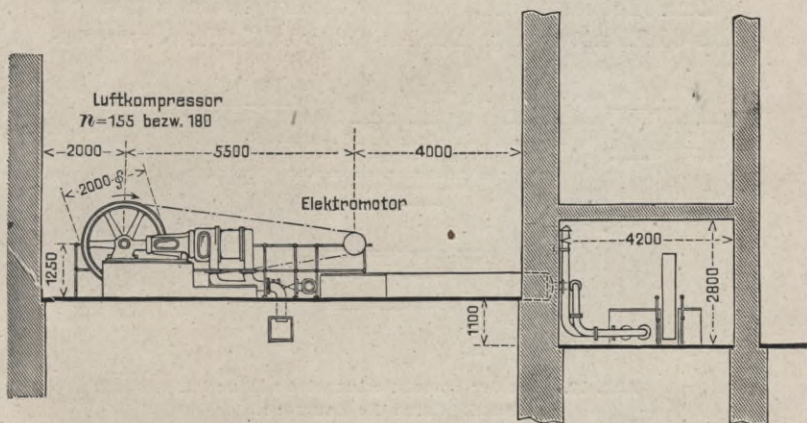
Bau der Spreeuntertunnelung in Berlin.
